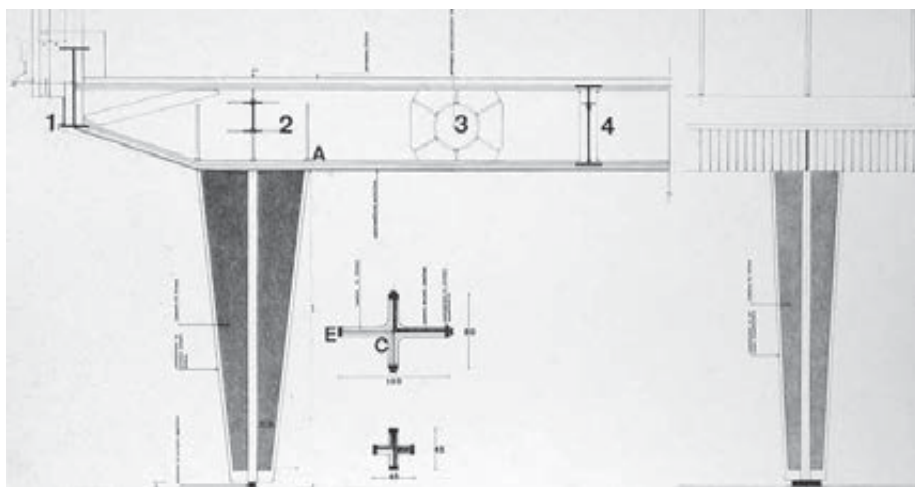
Sezione-prospetto di dettaglio (AB)
